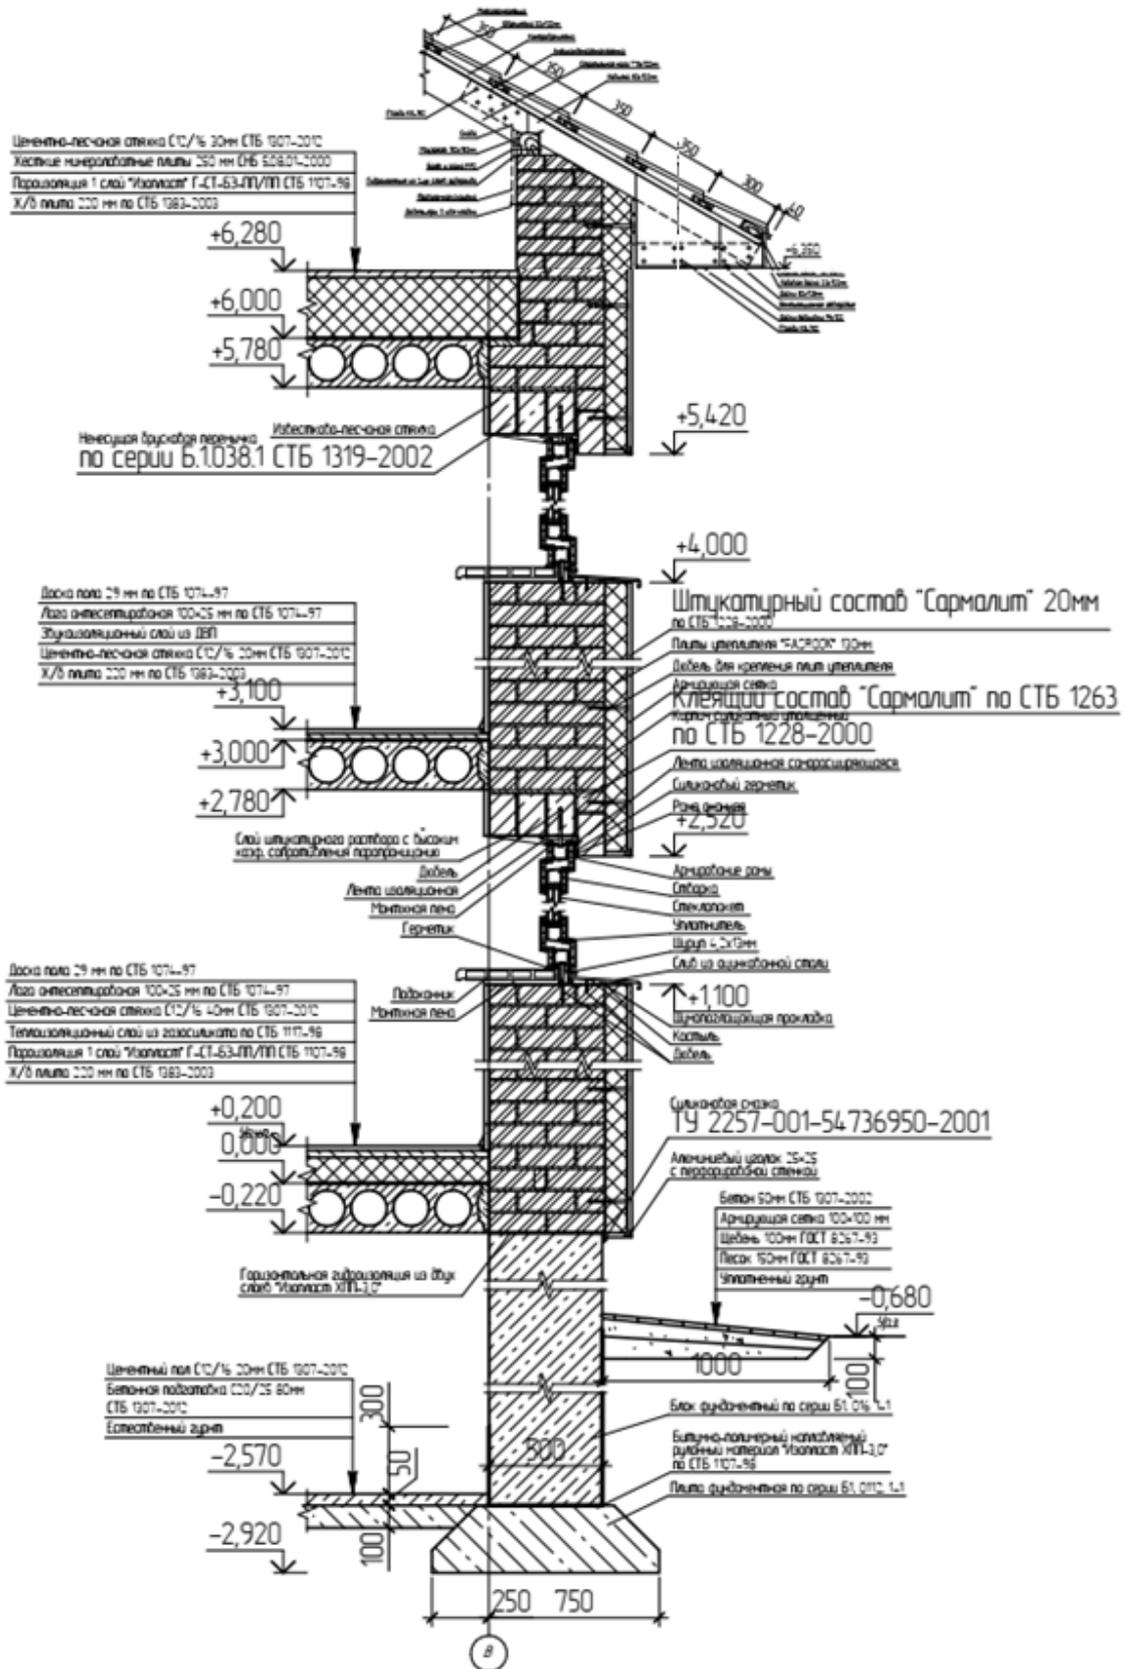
Пример выполнения сечения 2-2 по наружной стене
